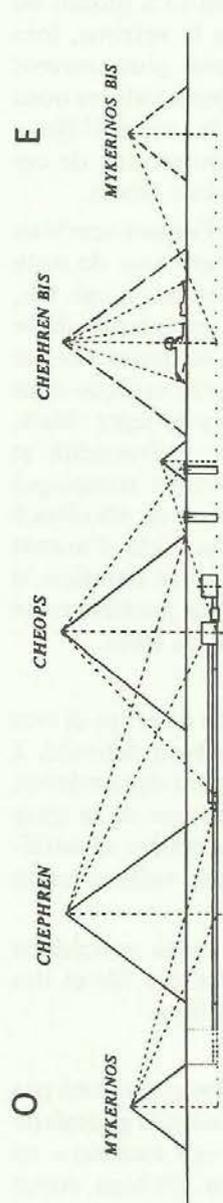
COUPE I: Coupe générale du plateau, d'ouest en est, regardée vers le nord sur un même plan.
